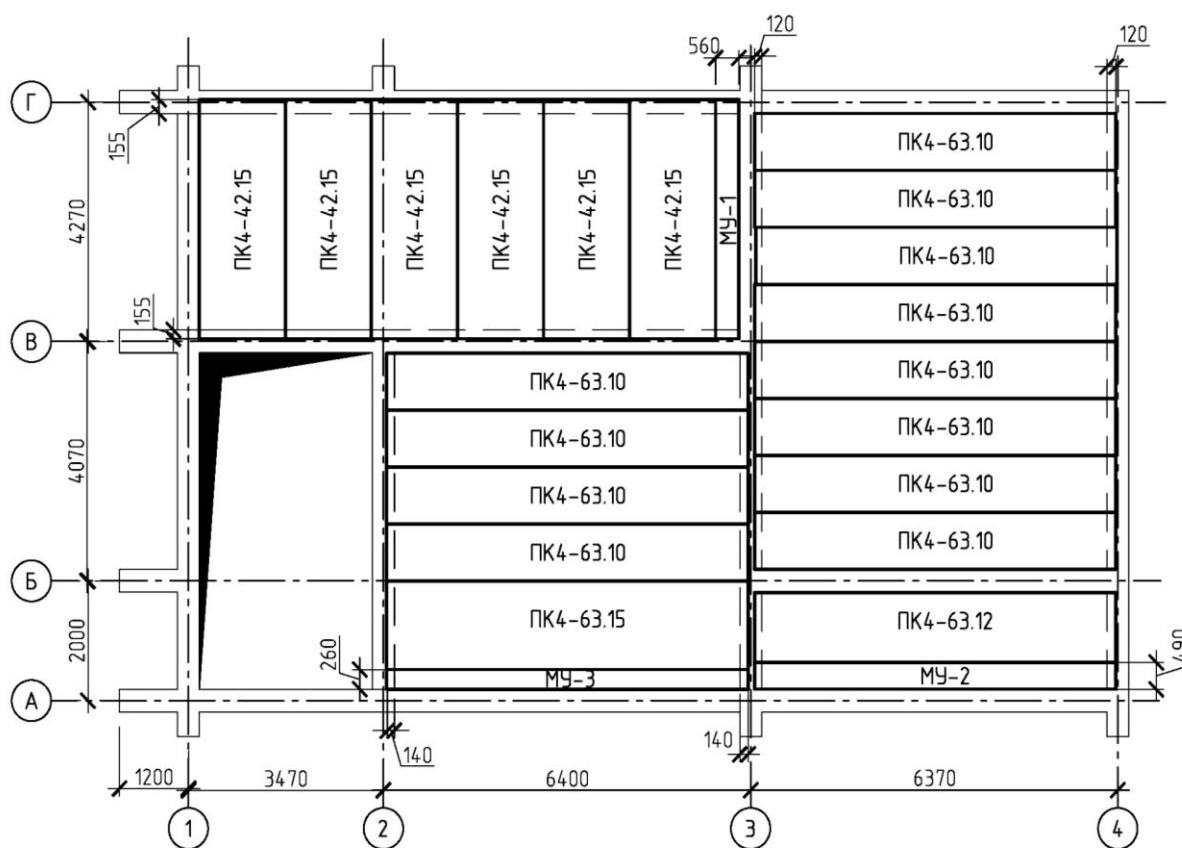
Схема раскладки плит междуэтажного перекрытия
